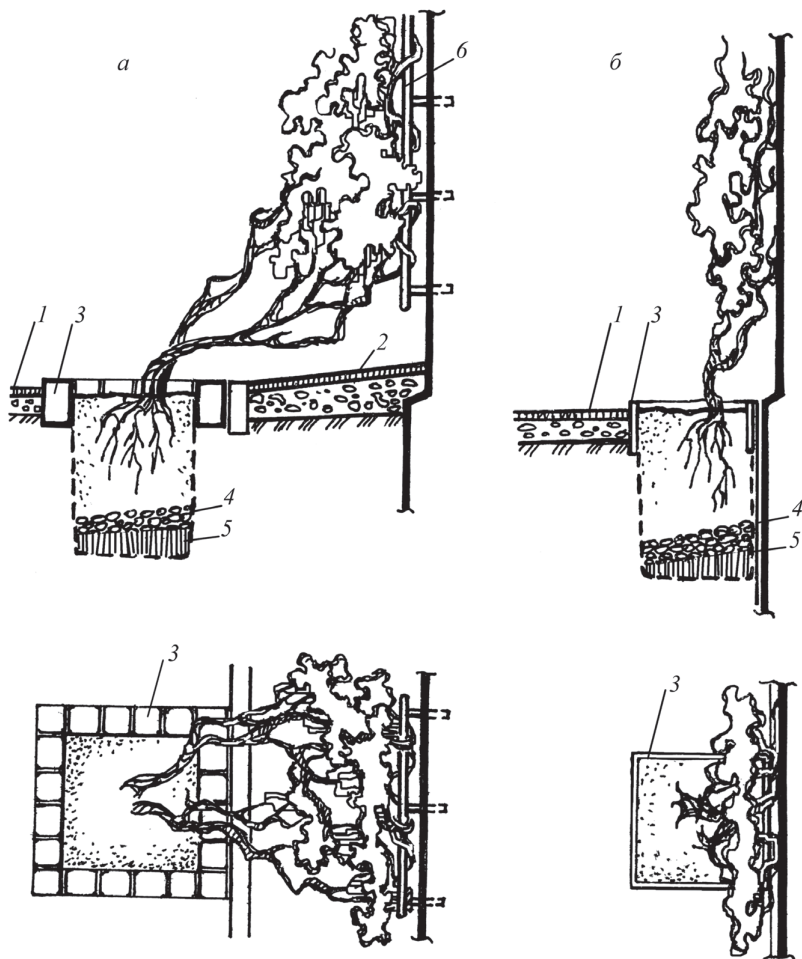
Схемы посадки лиан для вертикального озеленения фасадов:
